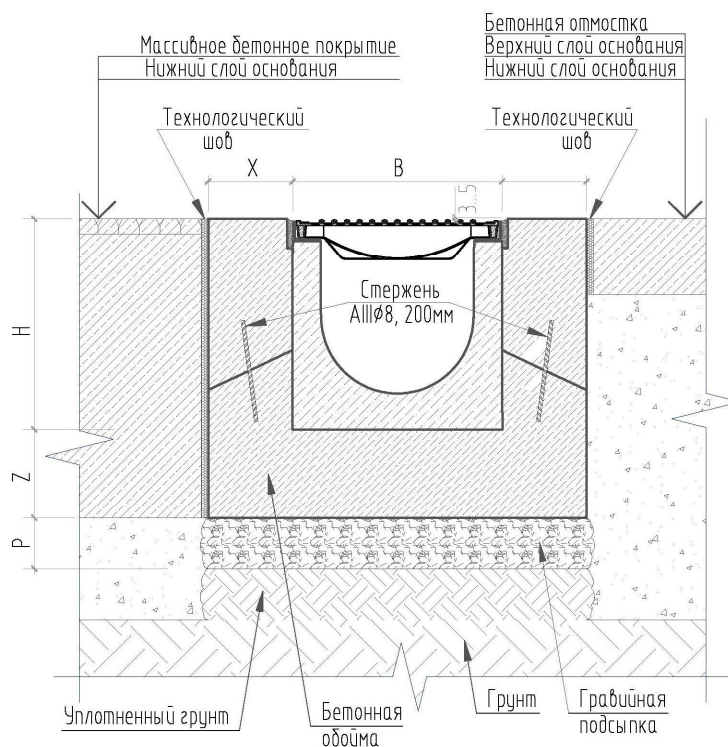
Монтаж бетонных лотков с бетонным покрытием для высоких классов нагрузки от D400 до E600.
